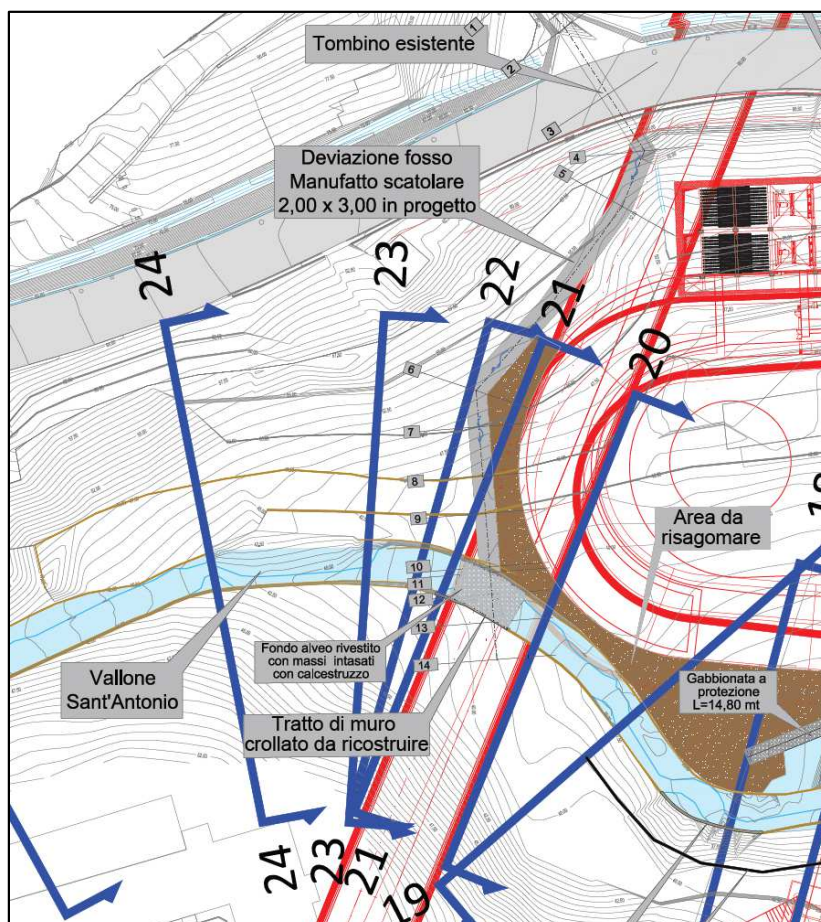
Stralcio planimetrico deviazione fosso Vallone Sant'Antonio alla Pk 13+700
